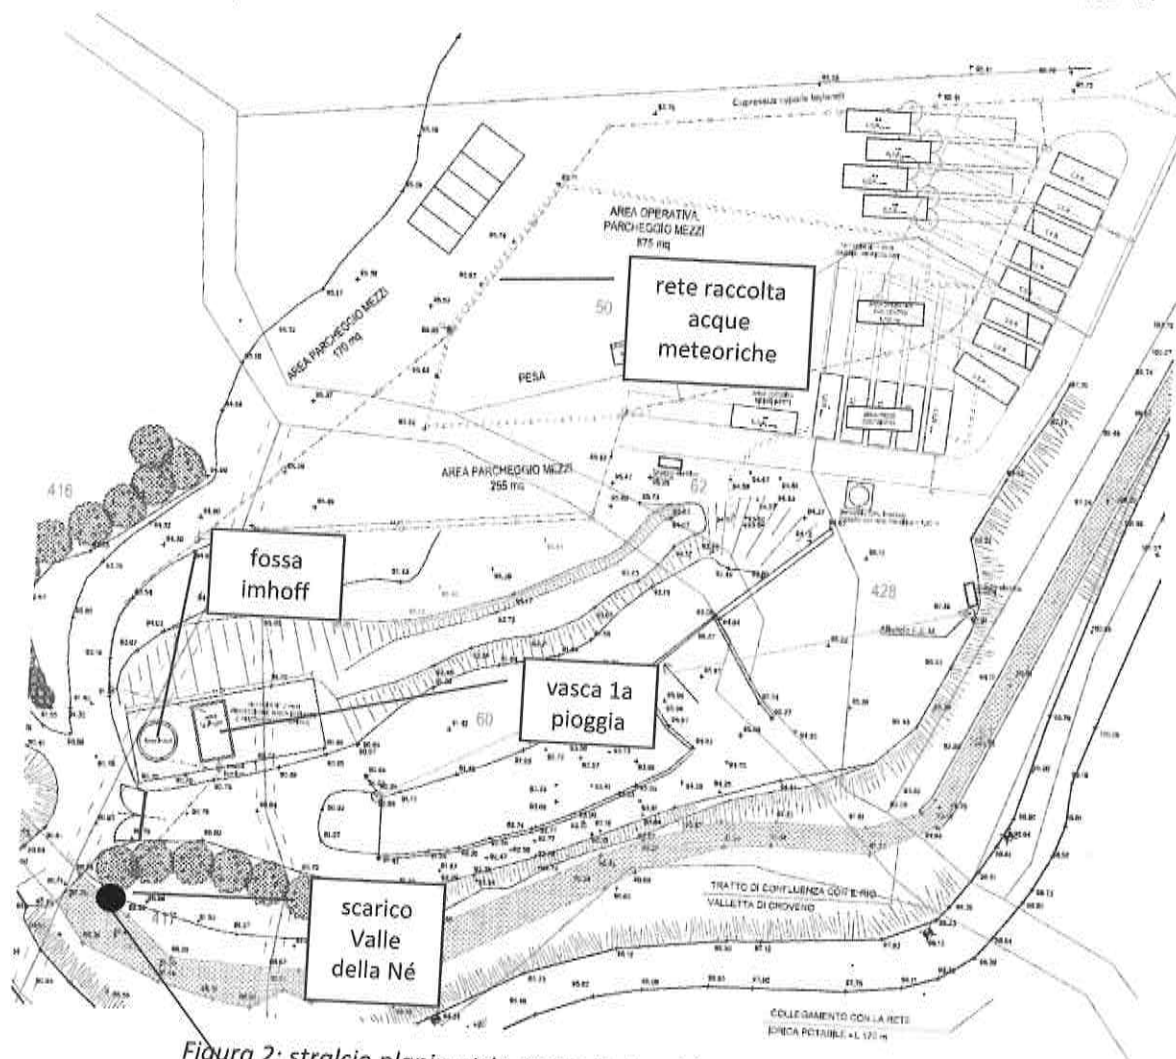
stralcio planimetria acque meteoriche (da Disegno D02)
